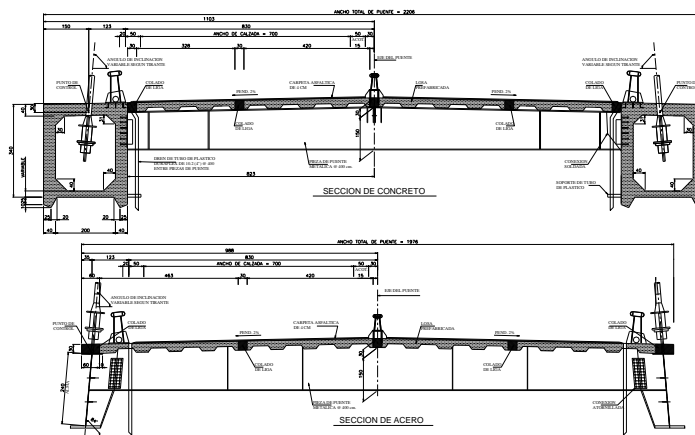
Vista en elevación de las secciones transversales de la superestructura del puente Baluarte
